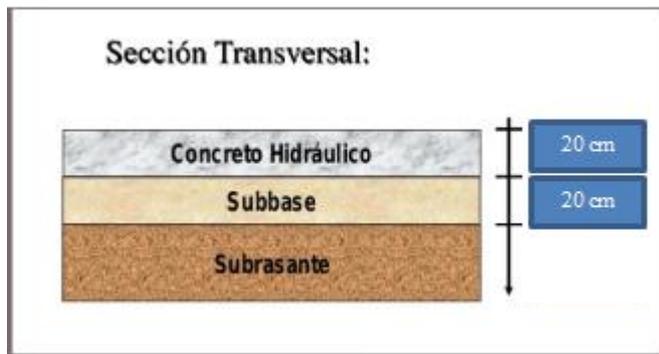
Mostrando la estructura del pavimento estudiado, de losa y sub-base.
